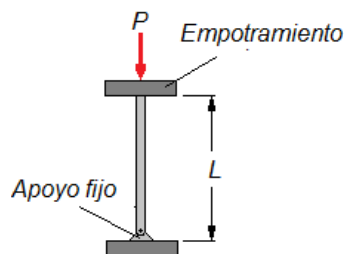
Apoyos de las columnas (Fuente: Propia)
